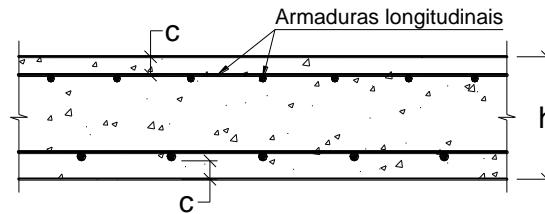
Cobrimento da armadura longitudinal na laje maciça.
